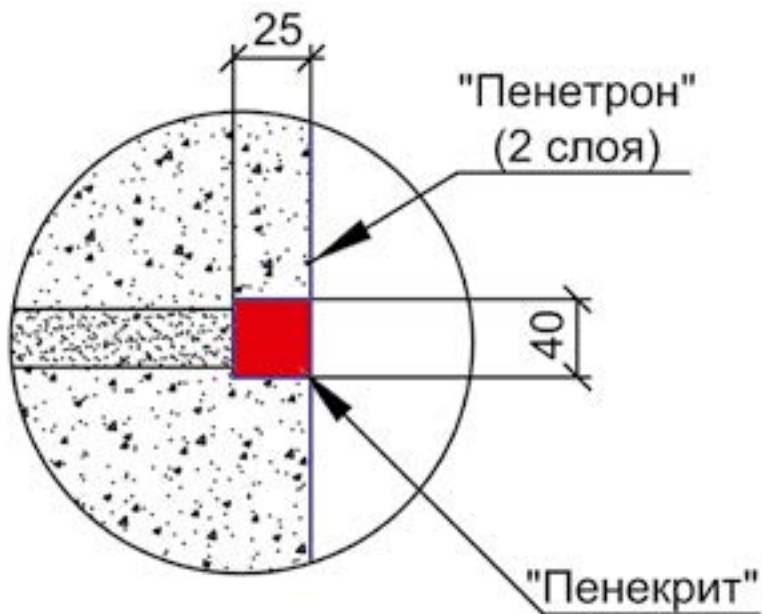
Схема гидроизоляции шва между бетонными кольцами
